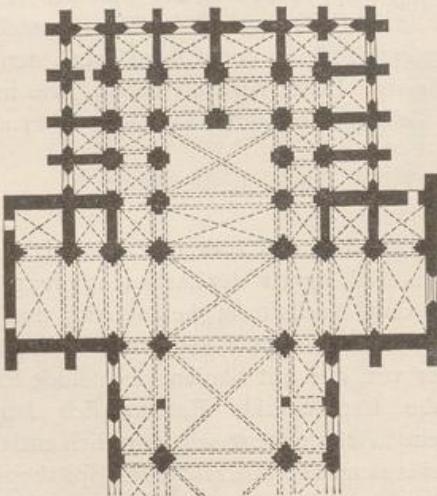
Grundriss von Ebrach. (Nach v. Quaft.)
